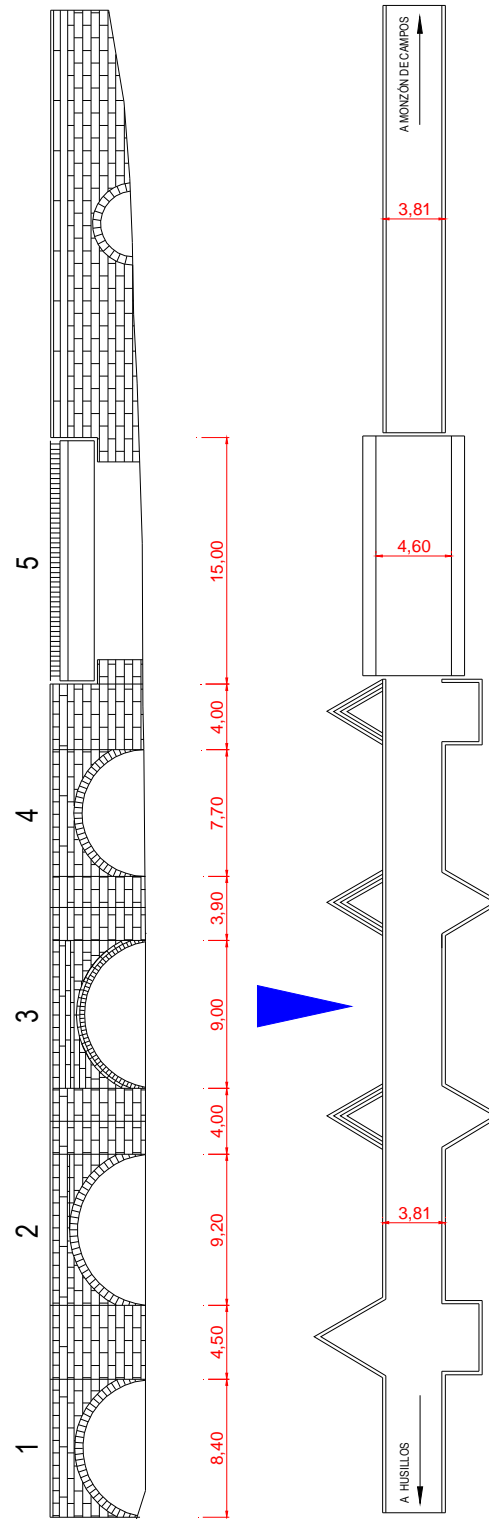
Planta y alzado de aguas abajo del puente en Husillos
